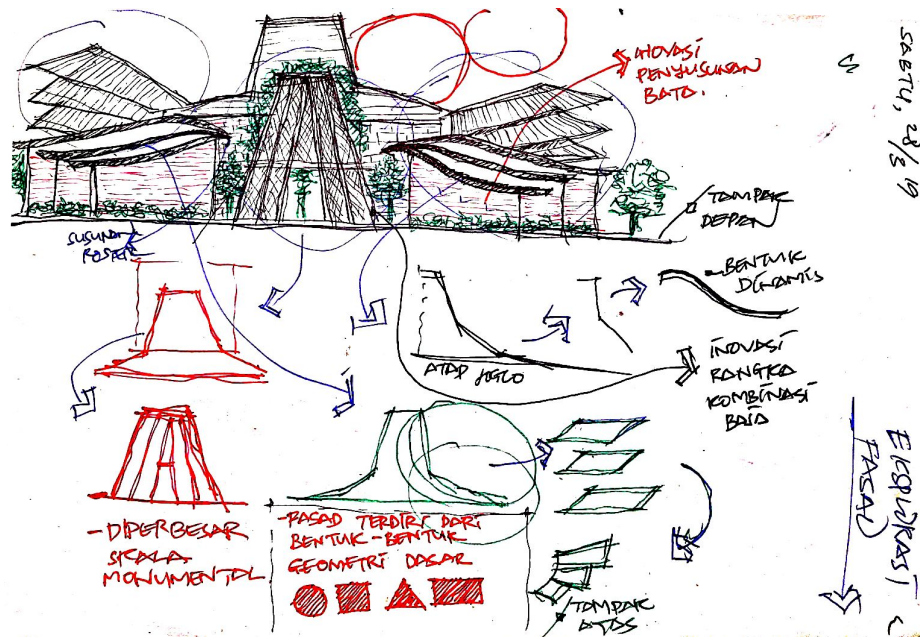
Penyelesaian Bentuk Bangunan
